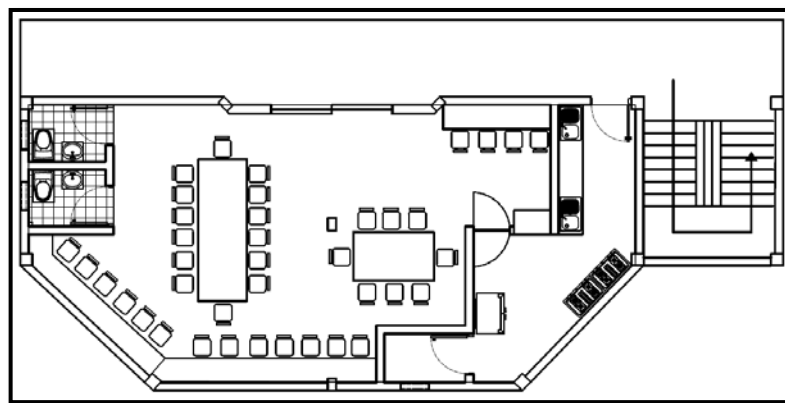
Detalle del comedor escolar (Planta baja del edificio administrativo)
